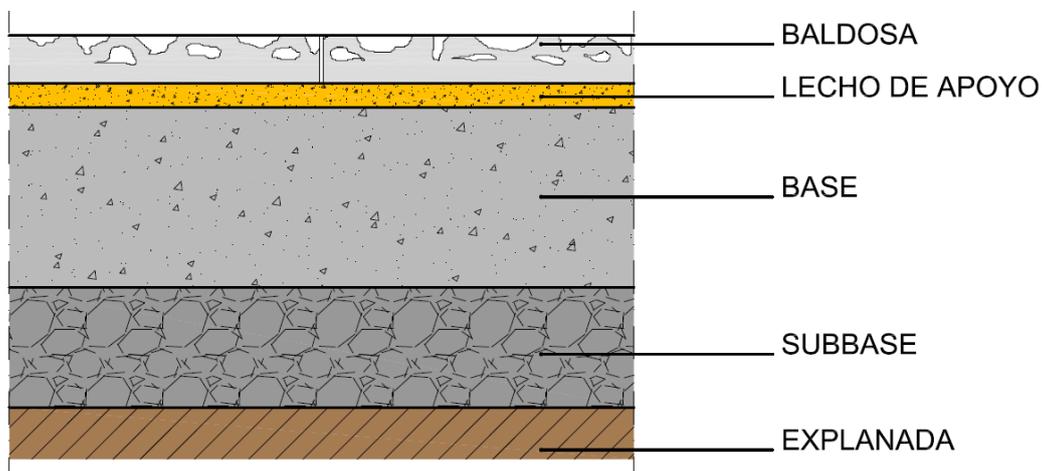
Capas que componen el sistema constructivo de un pavimento.
